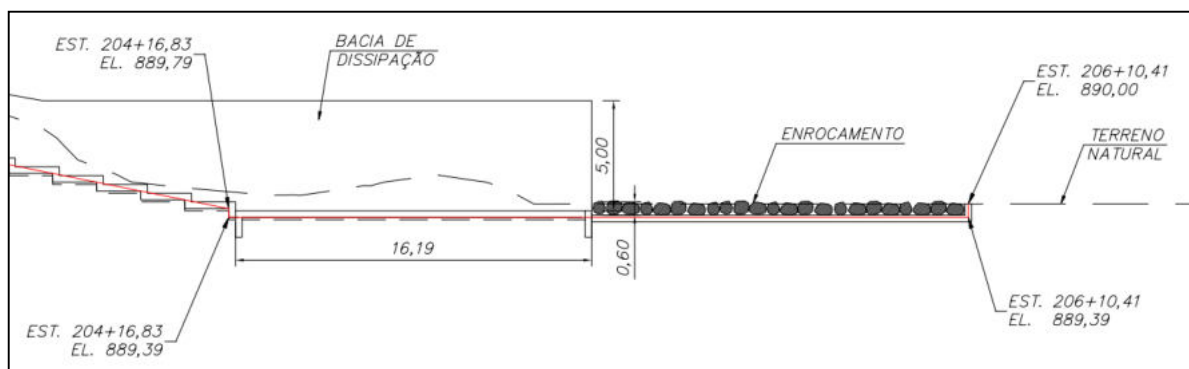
Perfil longitudinal da Bacia de Dissipação.
